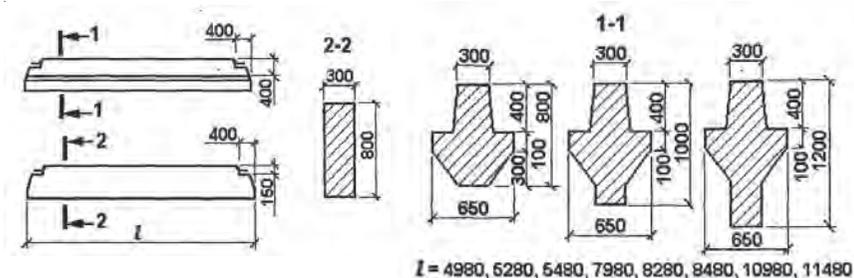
Унифицированные железобетонные ригели перекрытий
